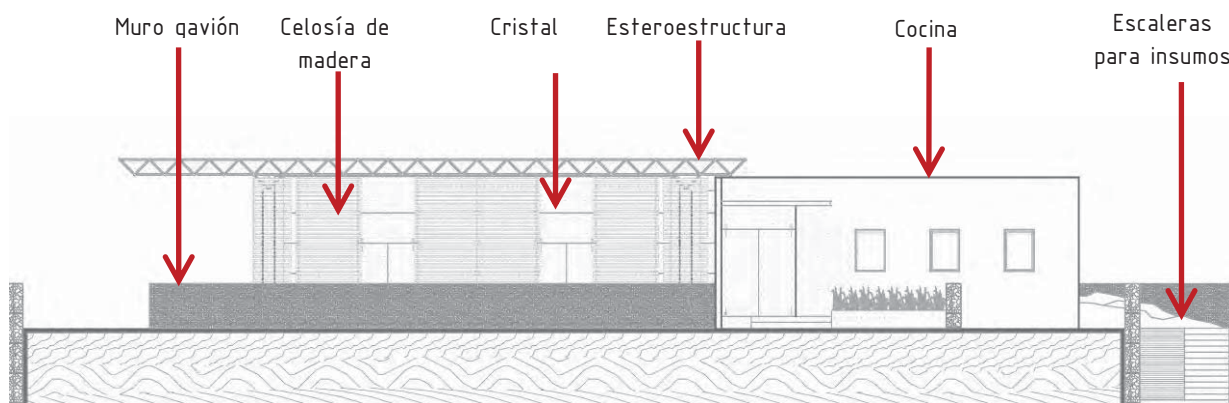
Fachada oriente de la Cafetería; en la fachada se ve el muro gavión que es una constante en el proyecto, ya que se ocuparon como muros de contención entre para delimitar las plataformas, en la fachada también se aprecia el cristal que está detrás de las celosías de aluminio, así como la estereoestructura y el acceso directo del estacionamiento para la llegada de insumos a la cocina.
